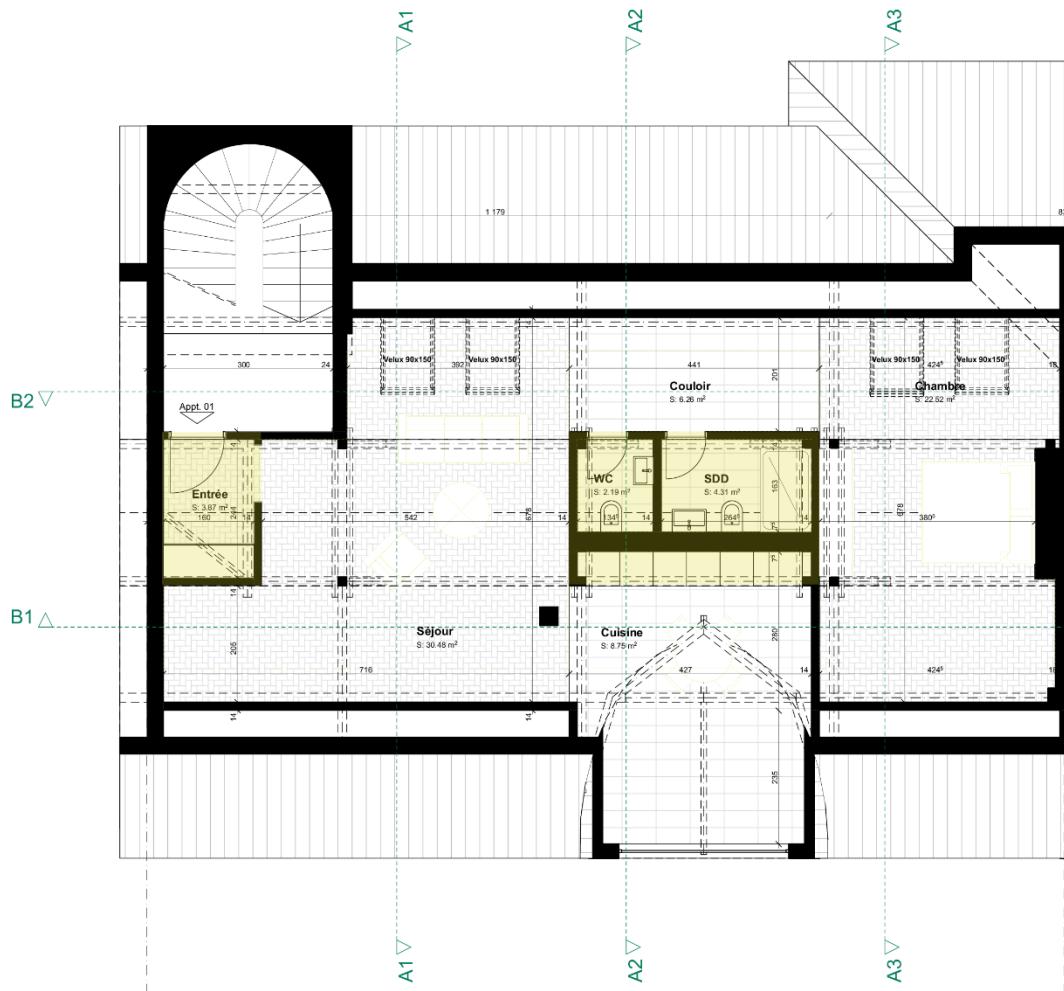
Plan Combles ML11 – Appartement 1 – Nouvelle proposition
